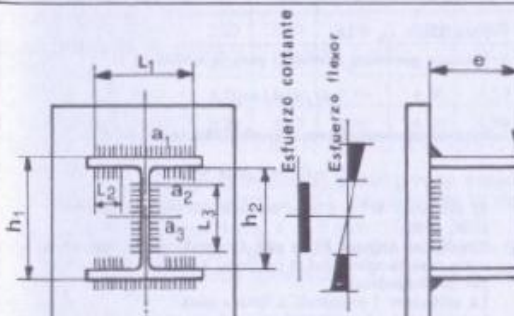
[1]: Unions per soldadura.
